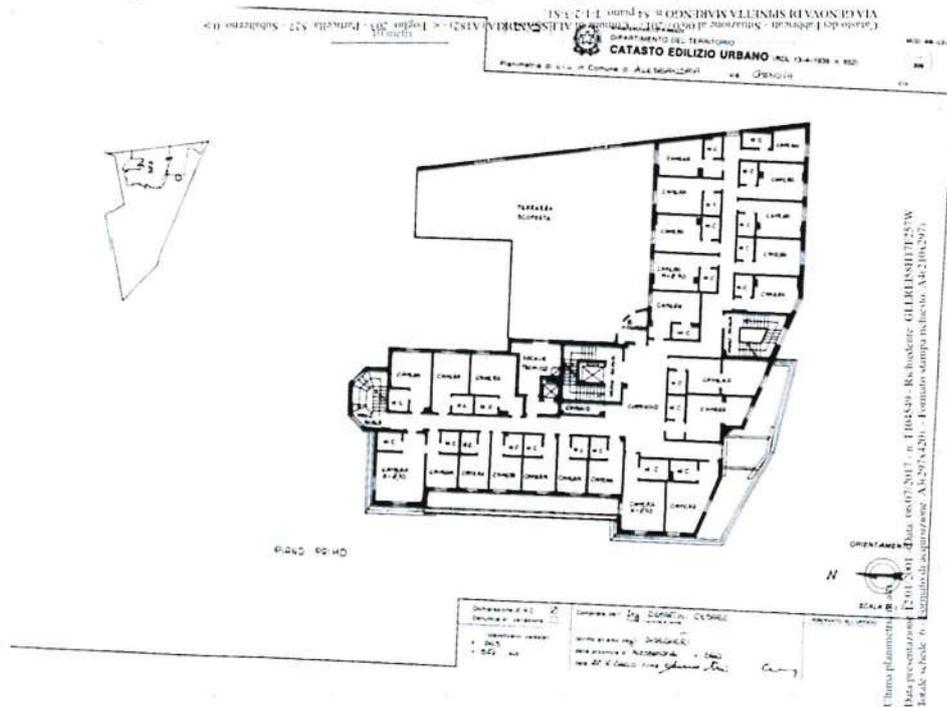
Part. 527 - Pianta piano secondo (3° F.T.)
